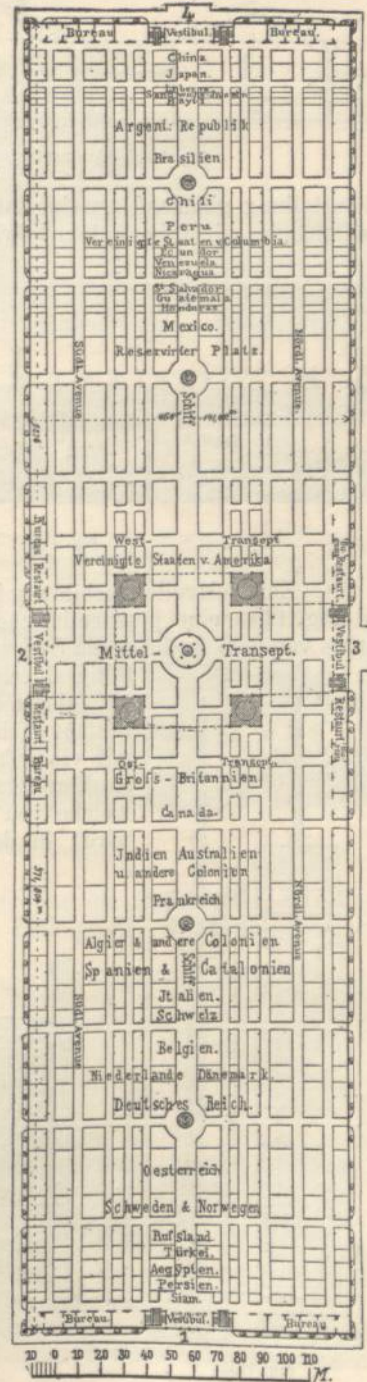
Grundriss vom Hauptgebäude.
